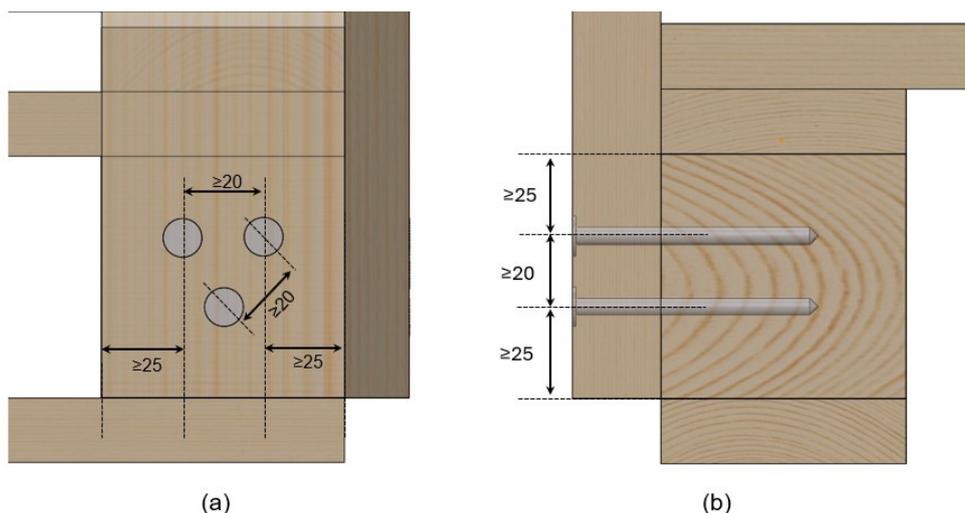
Distances aux bords préconisées pour l'assemblage du montant sur l'assise vues de face (a) et coupe (b)
